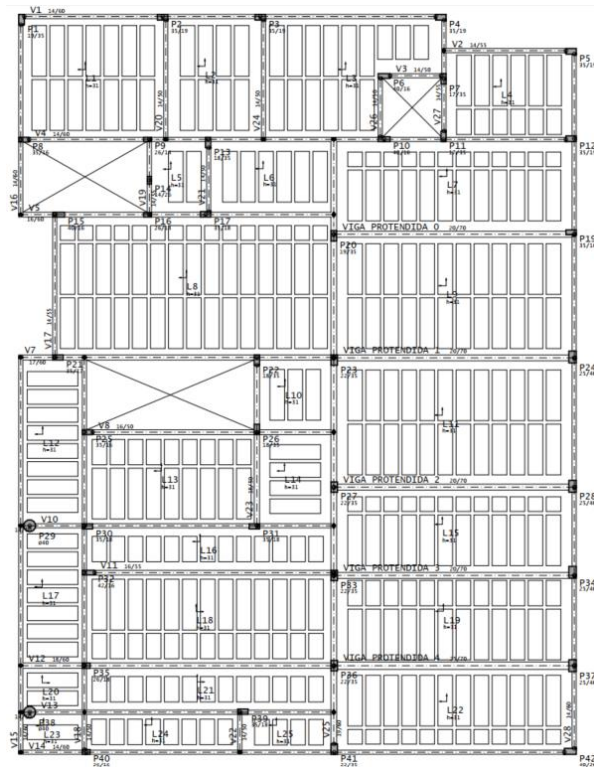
Planta de fôrma do sistema de laje nervurada unidirecional protendida no TQS. (Fonte: Autoria própria; 2023)
